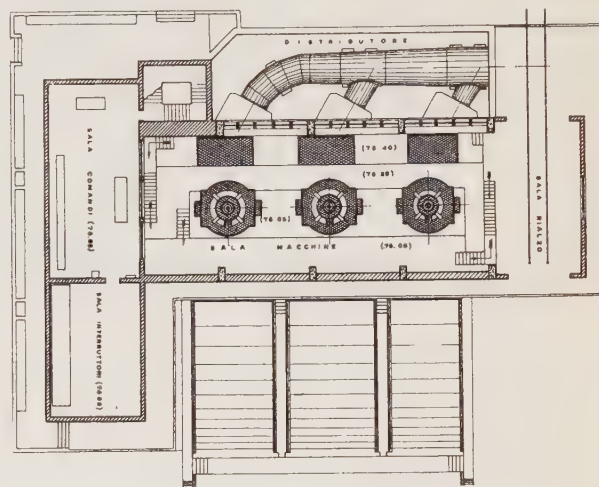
Pianta della Centrale di S. Lazzaro.
